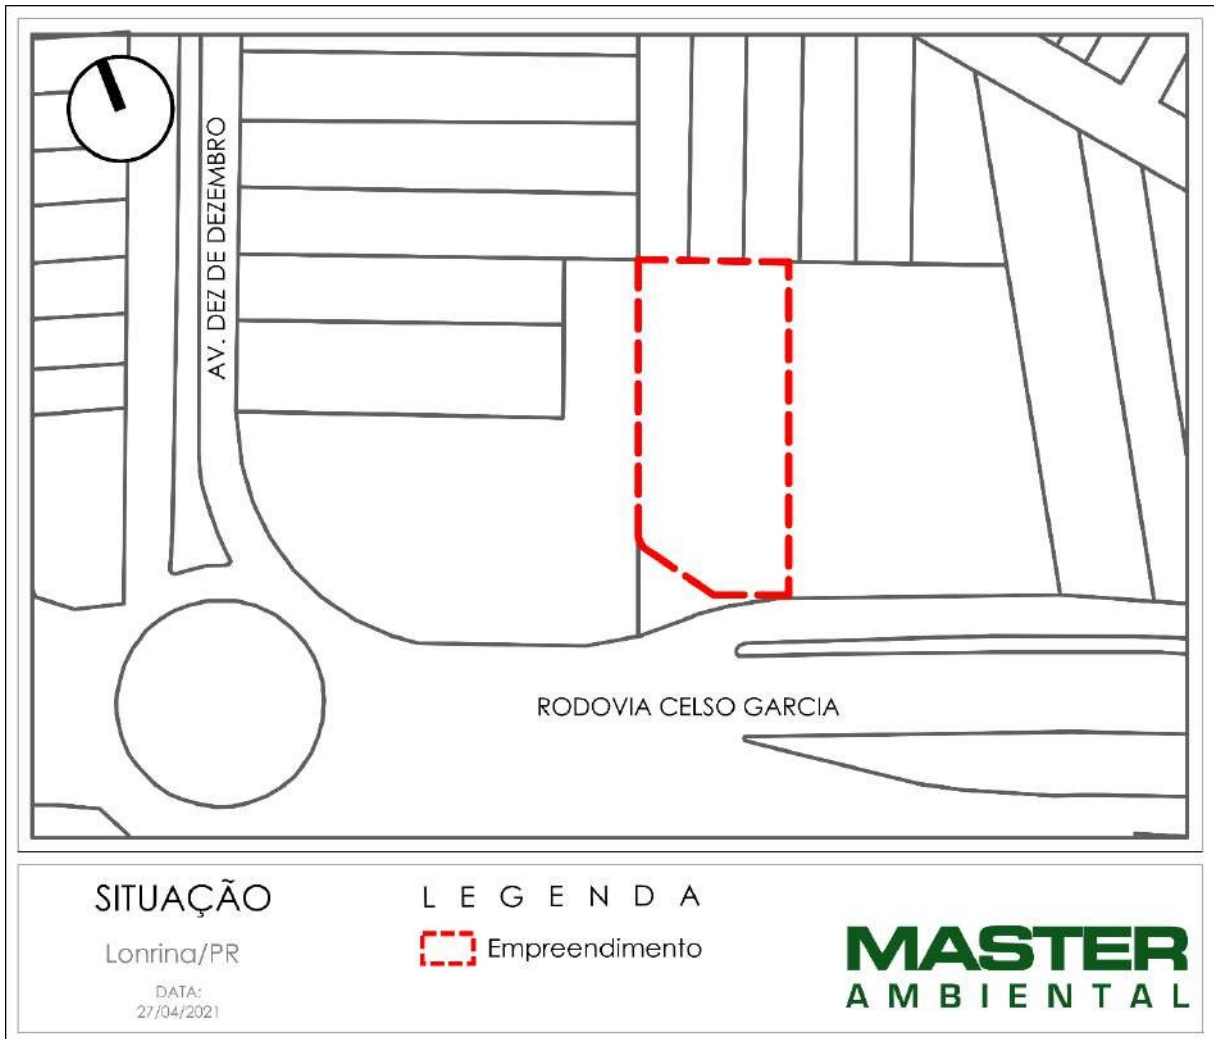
Planta de situação. Fonte: Projeto arquitetônico. Adaptação: Master Ambiental, 2021.
